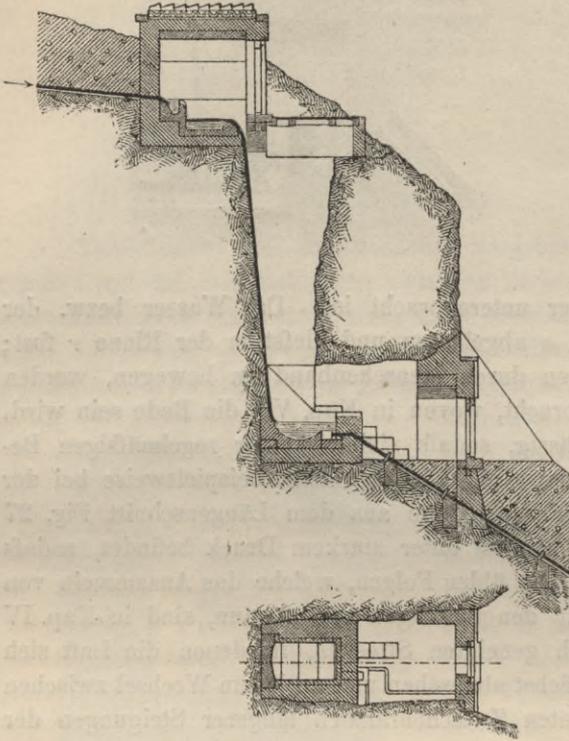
Zuleitung für das Wasserwerk der Stadt Salzburg.
